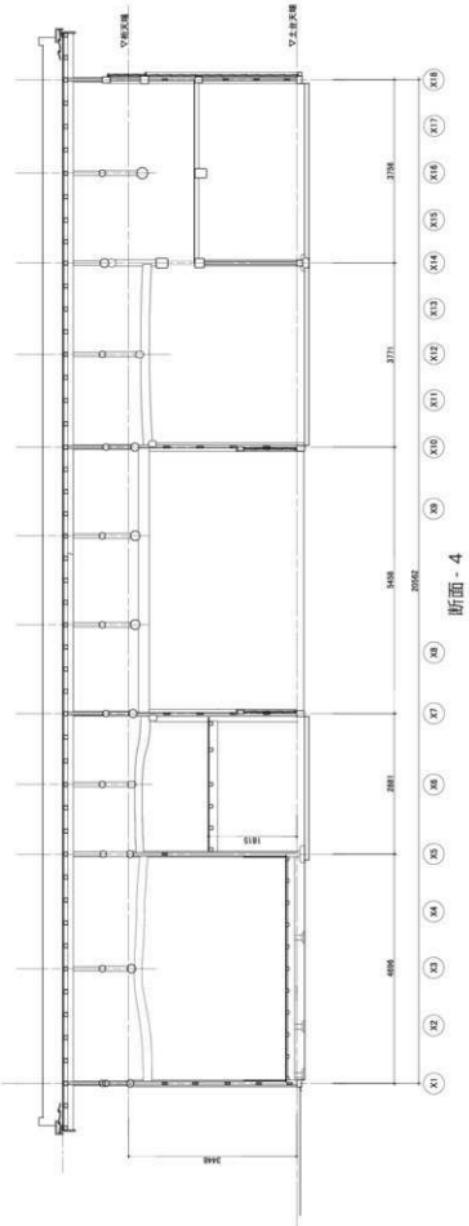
長屋門 竣工 断面図 2 S=1/100
